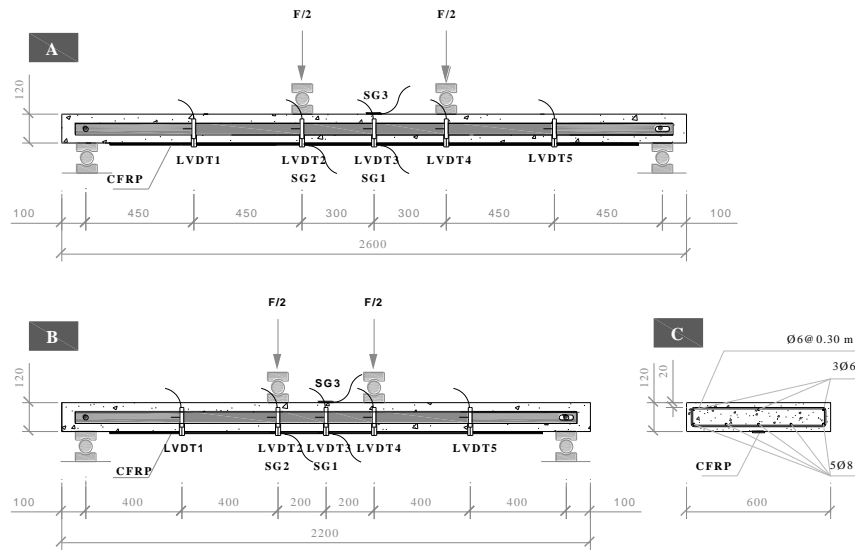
Geometria e configuração de ensaio das lajes da série S2600 (a) e S2400 (b), com secção transversal (c).
